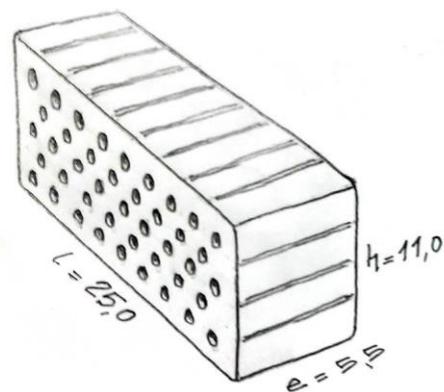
Detalle cubierta (capa inferior) y esquema de mampuesto.
